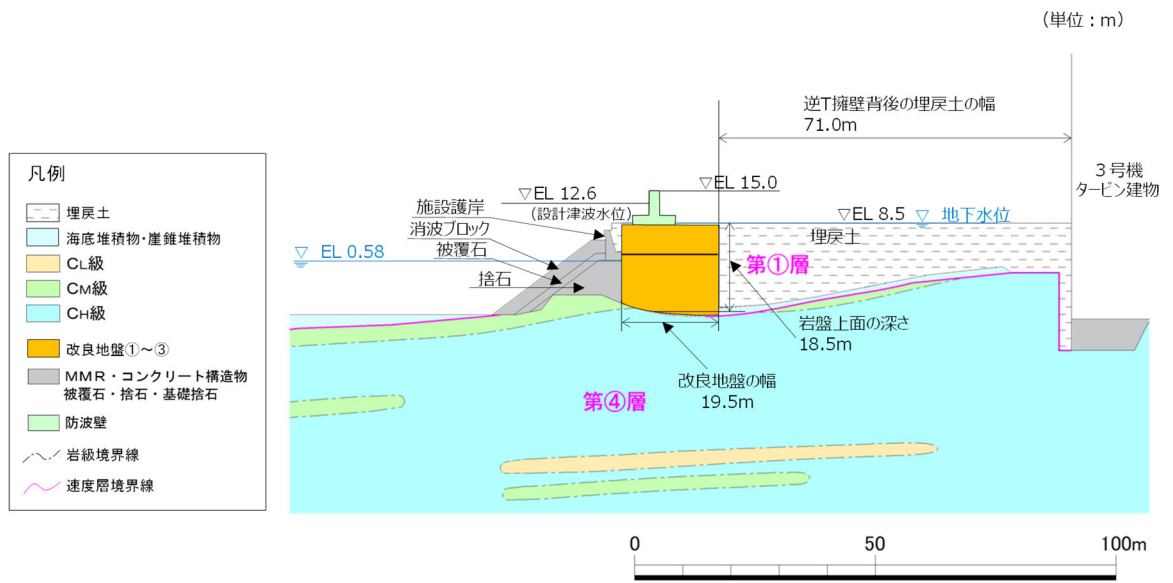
防波壁（逆 T 擁壁）の横断面図（⑤-⑤断面）
